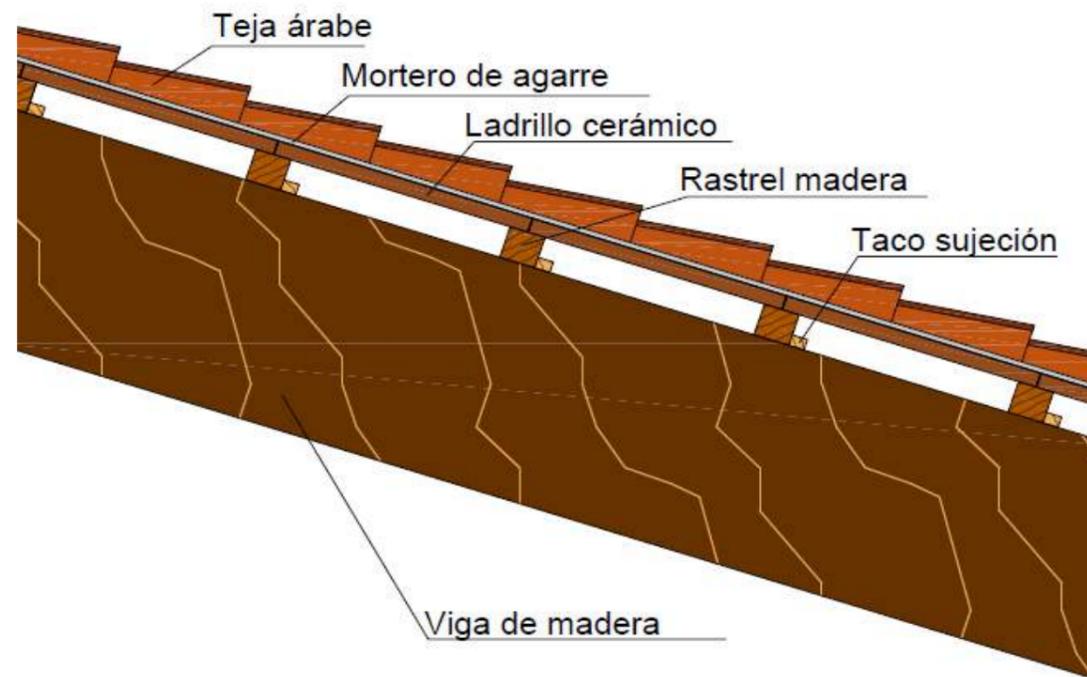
Detalle constructivo forjado, 2016. Fuente: Propio autor
